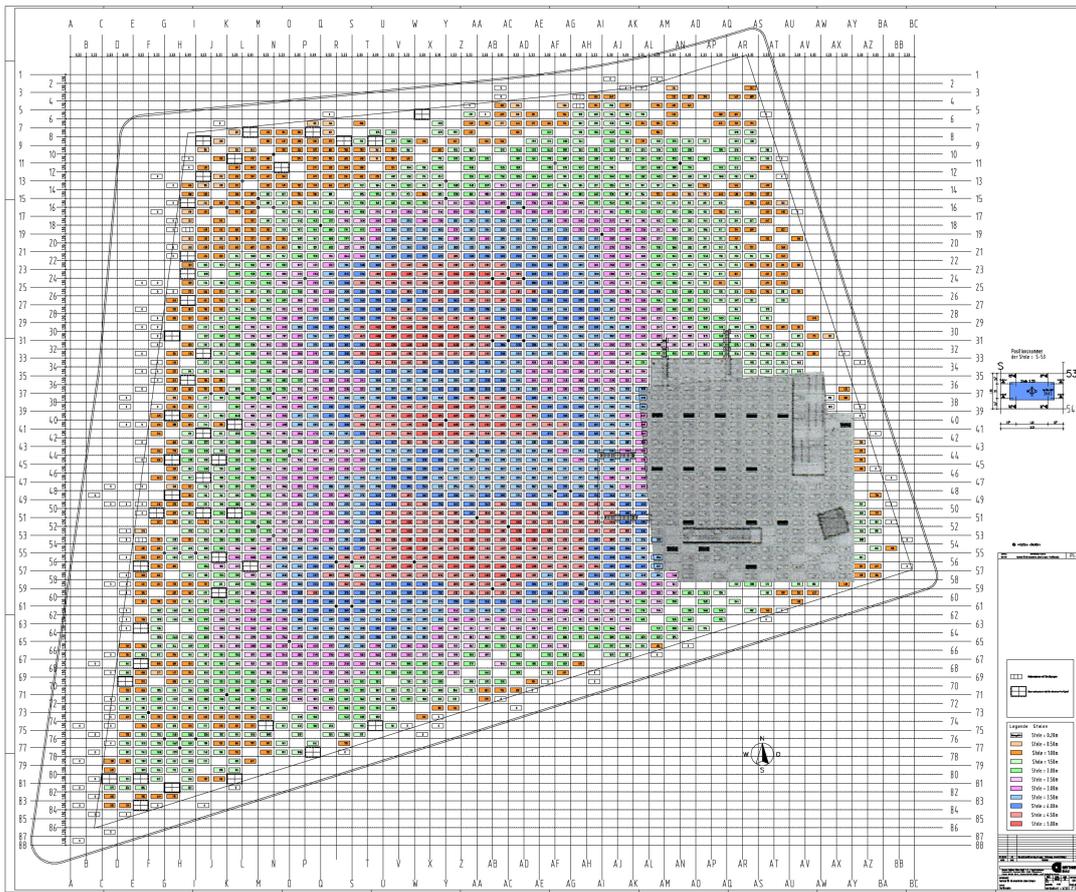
Planta do Projeto Executivo do Memorial de Berlin. *Cortesia Eisenman Architects.
